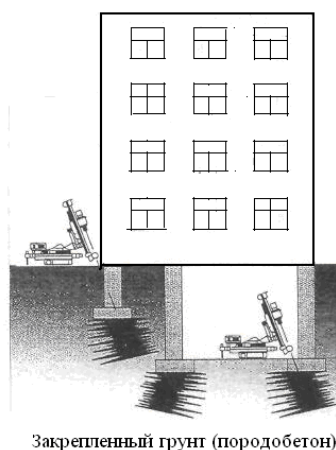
Схема усиления фундаментов с помощью буроинъекционных «корневидных» свай»
